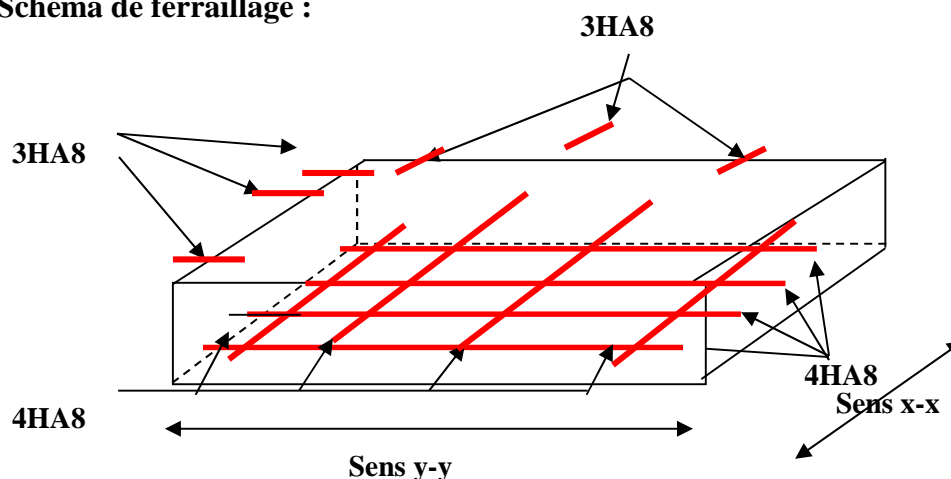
Schéma de ferrailage de la dalle pleine du local machinerie.
